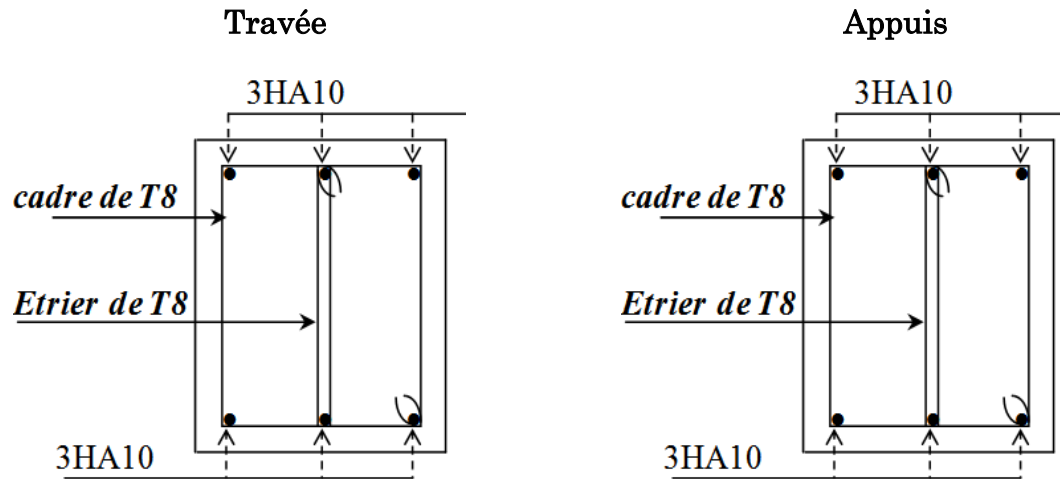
Schéma de ferrailage de la poutre inclinée
